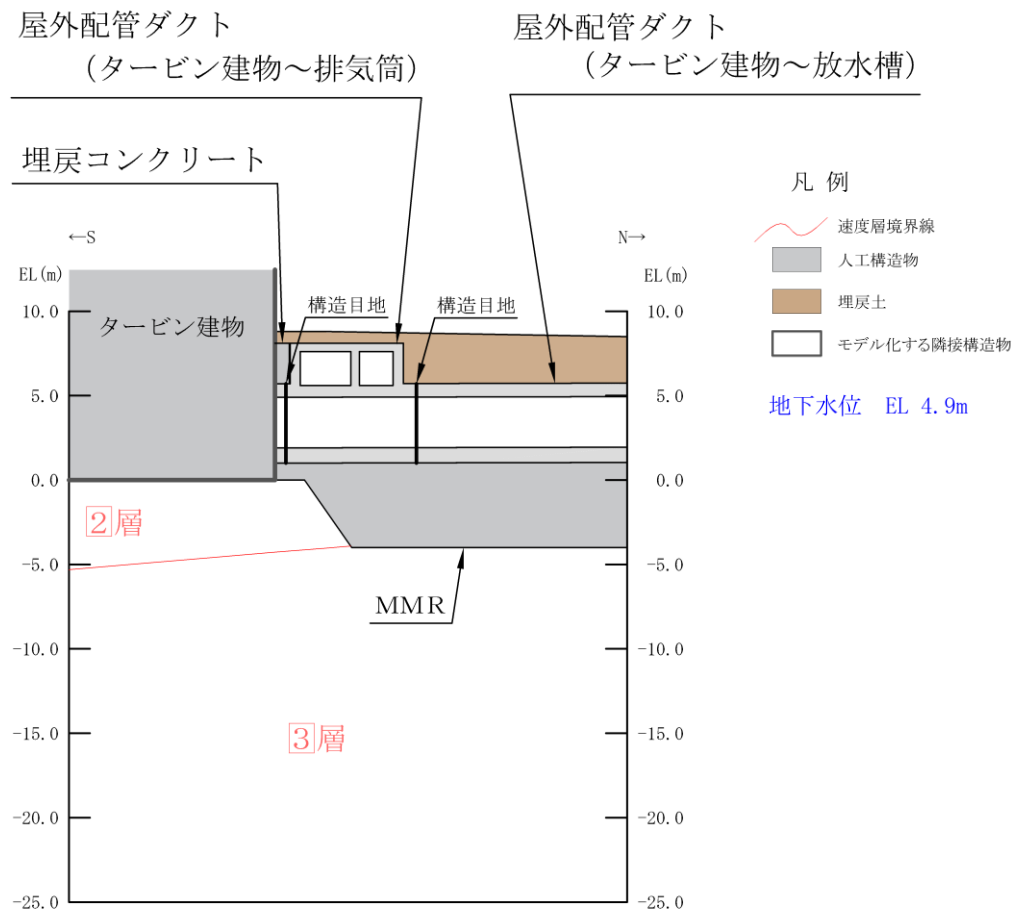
一体化部 地震時荷重算出断面図 (B-B 断面)
